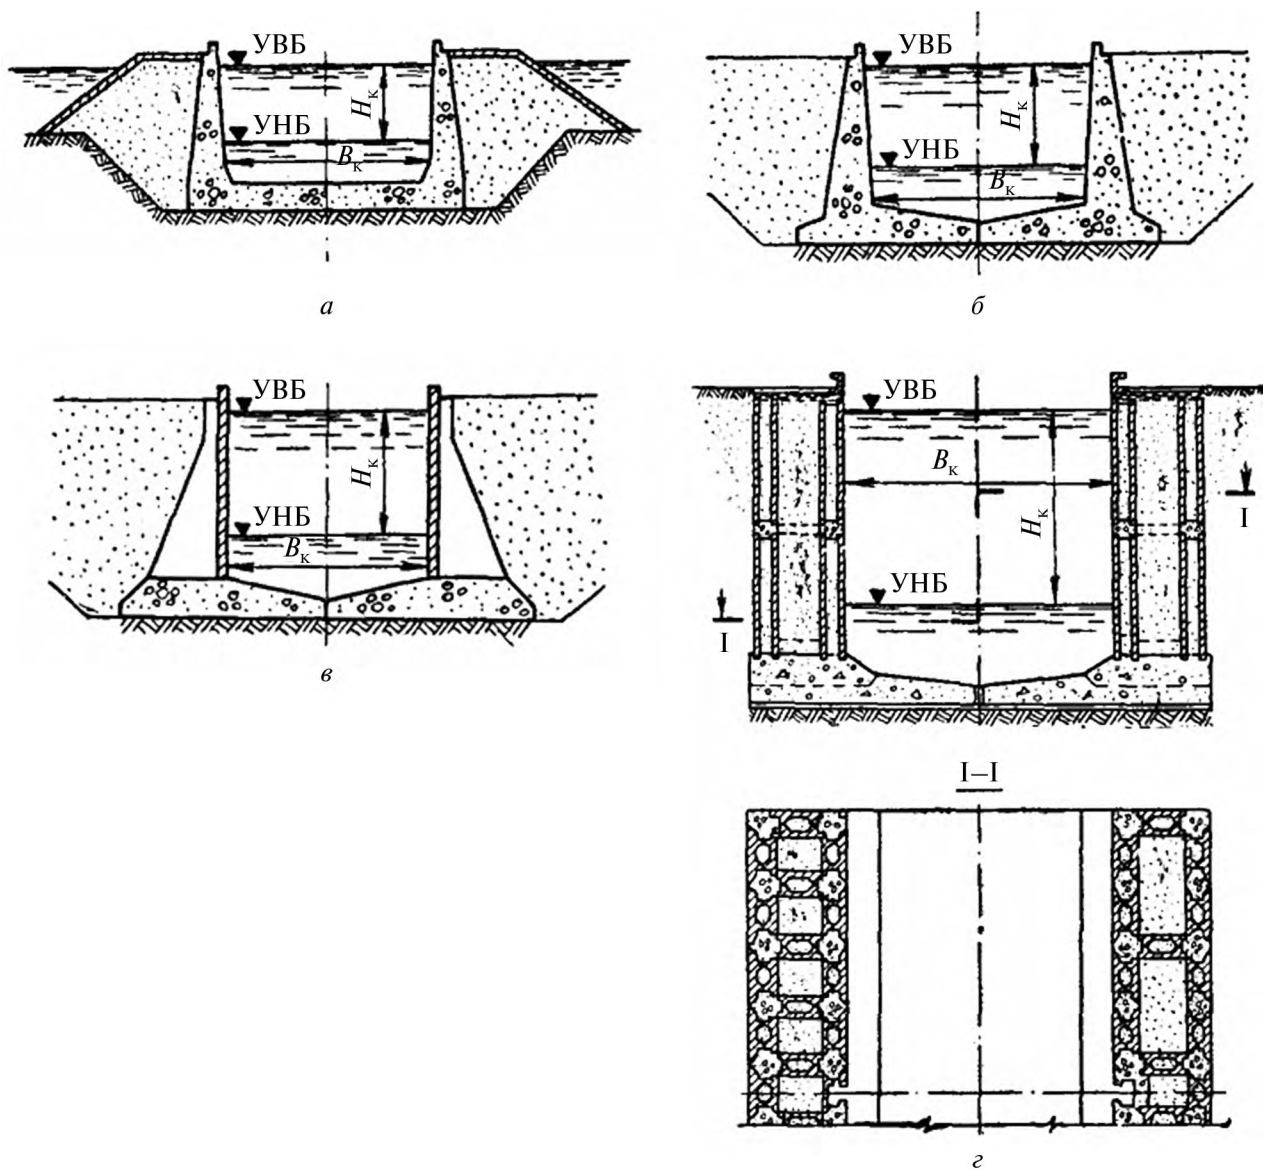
Железобетонные камеры шлюзов без продольных водопроводных галерей:
